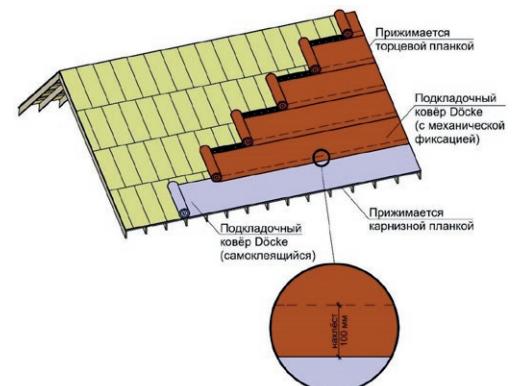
Схема расположения подкладочного ковра Döcke (последовательность укладки полотен в соответствии с пунктом 4.1.6.).
